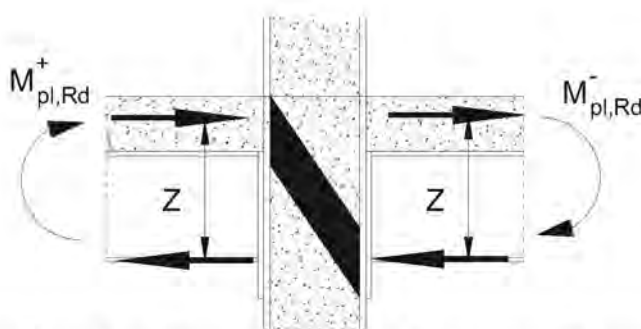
Definizione del braccio di coppia interna Z e rappresentazione del puntone di calcestruzzo attivo nell'assorbire le sollecitazioni di taglio
